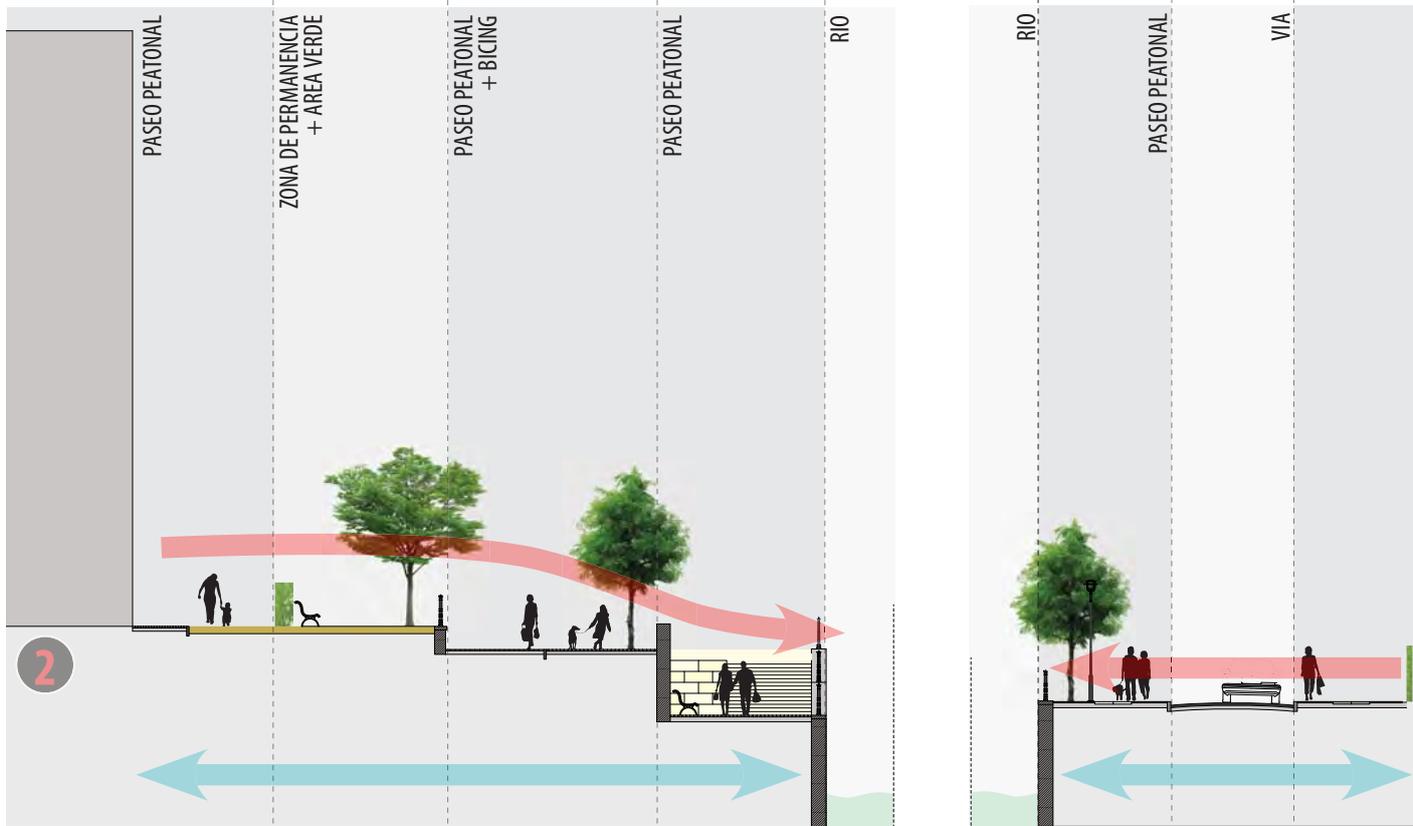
Sección tipo entre Marschallbrücke - Kronprinzenbrücke
